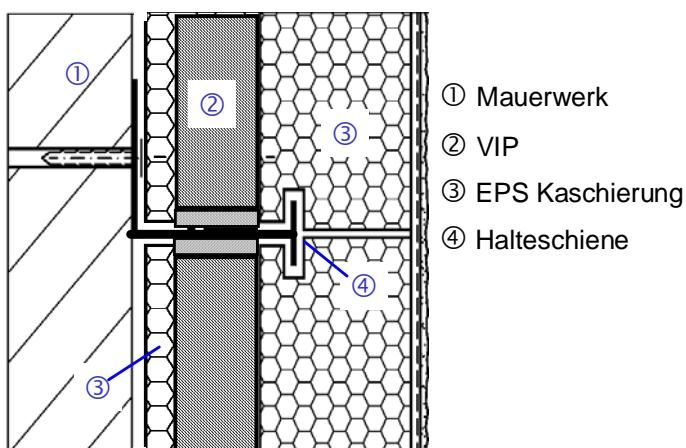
Integration von VIP in ein mechanisch befestigtes WDVS
